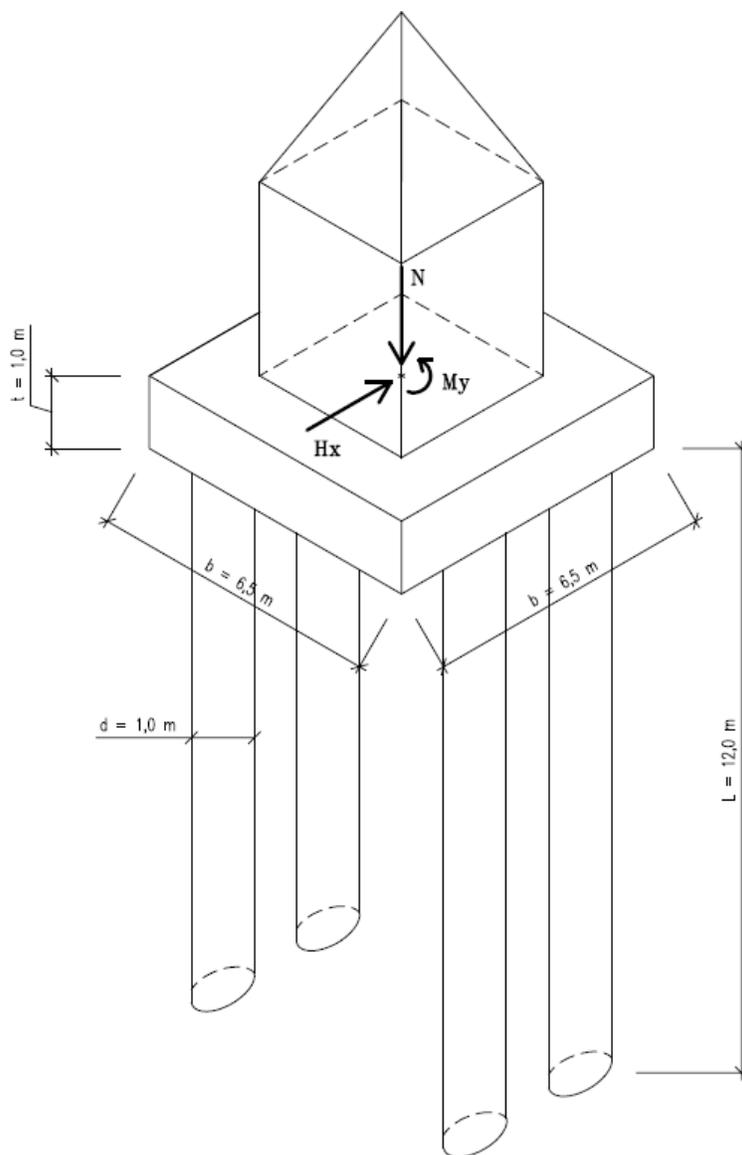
Schéma de spécification du problème - Fondation sur pieux
